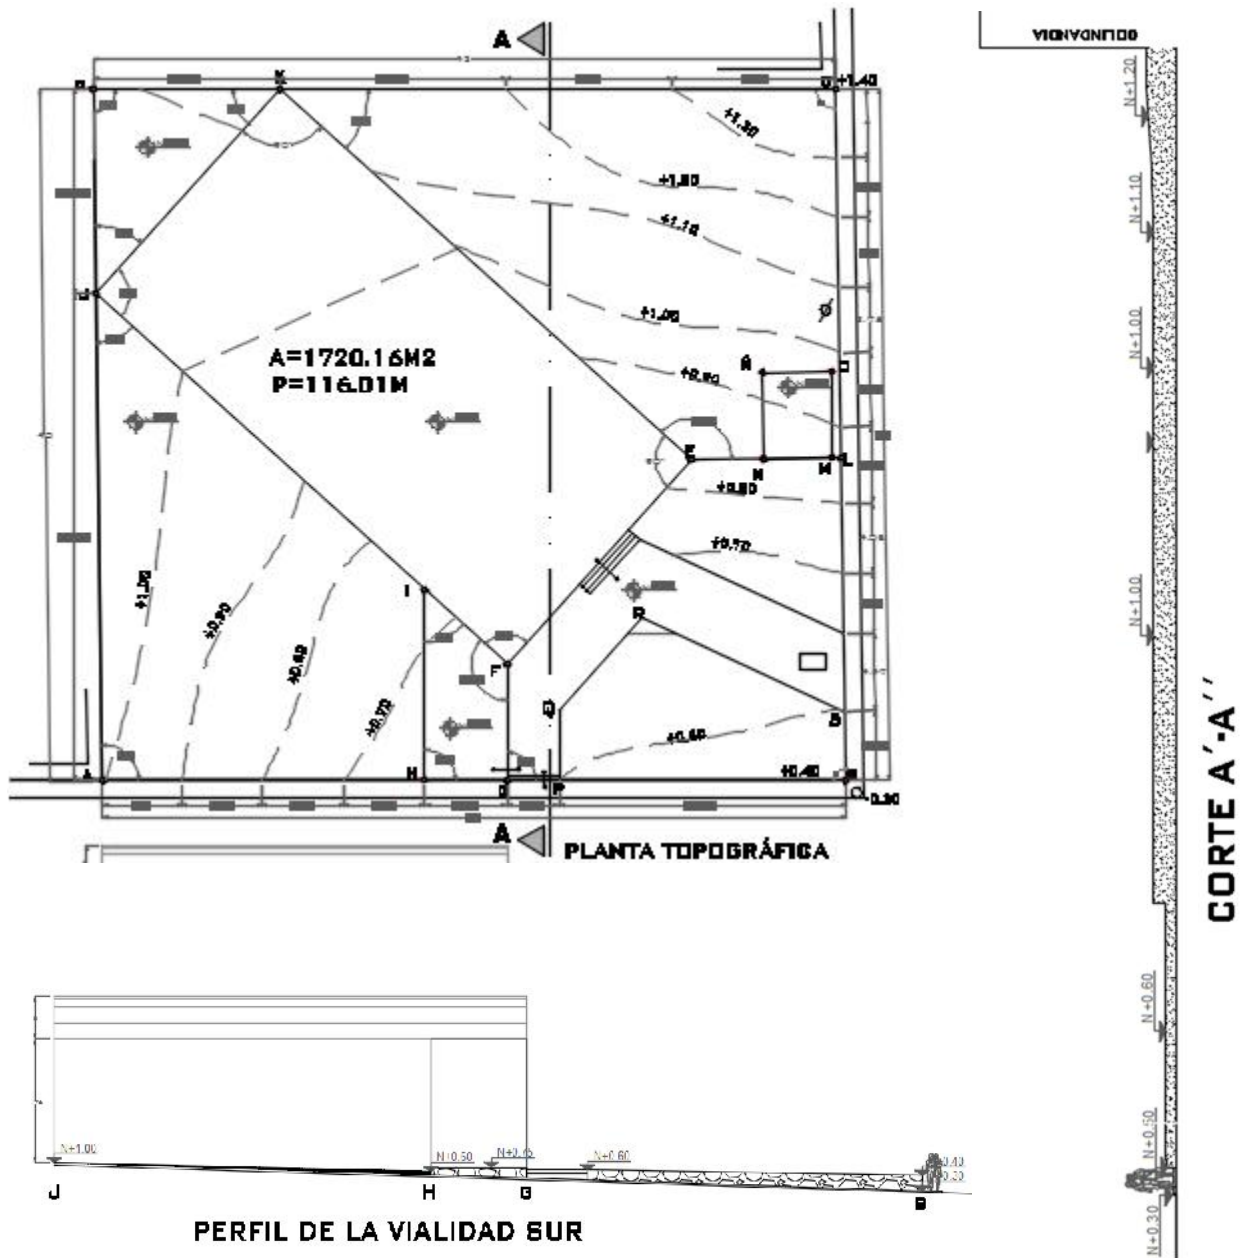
PLANO TOPOGRÁFICO Y PERFILES PROPIAS
